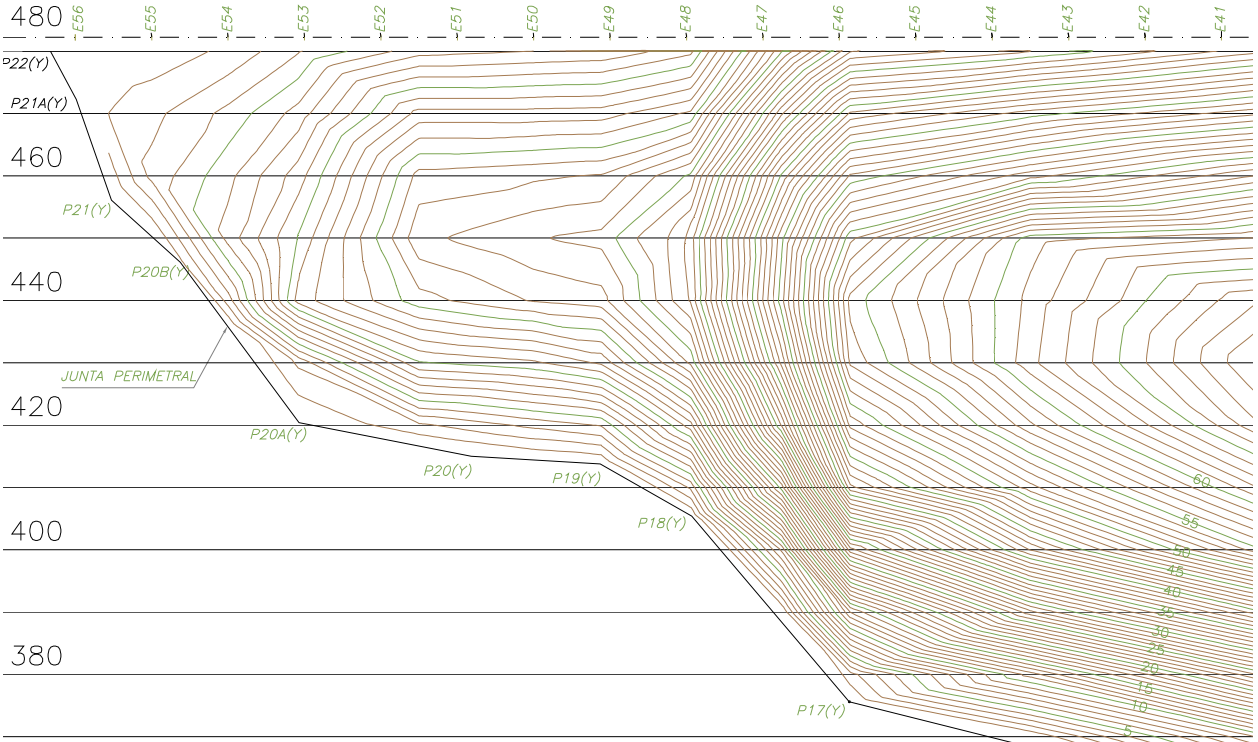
Indicação esquemática do comportamento da face de concreto.
